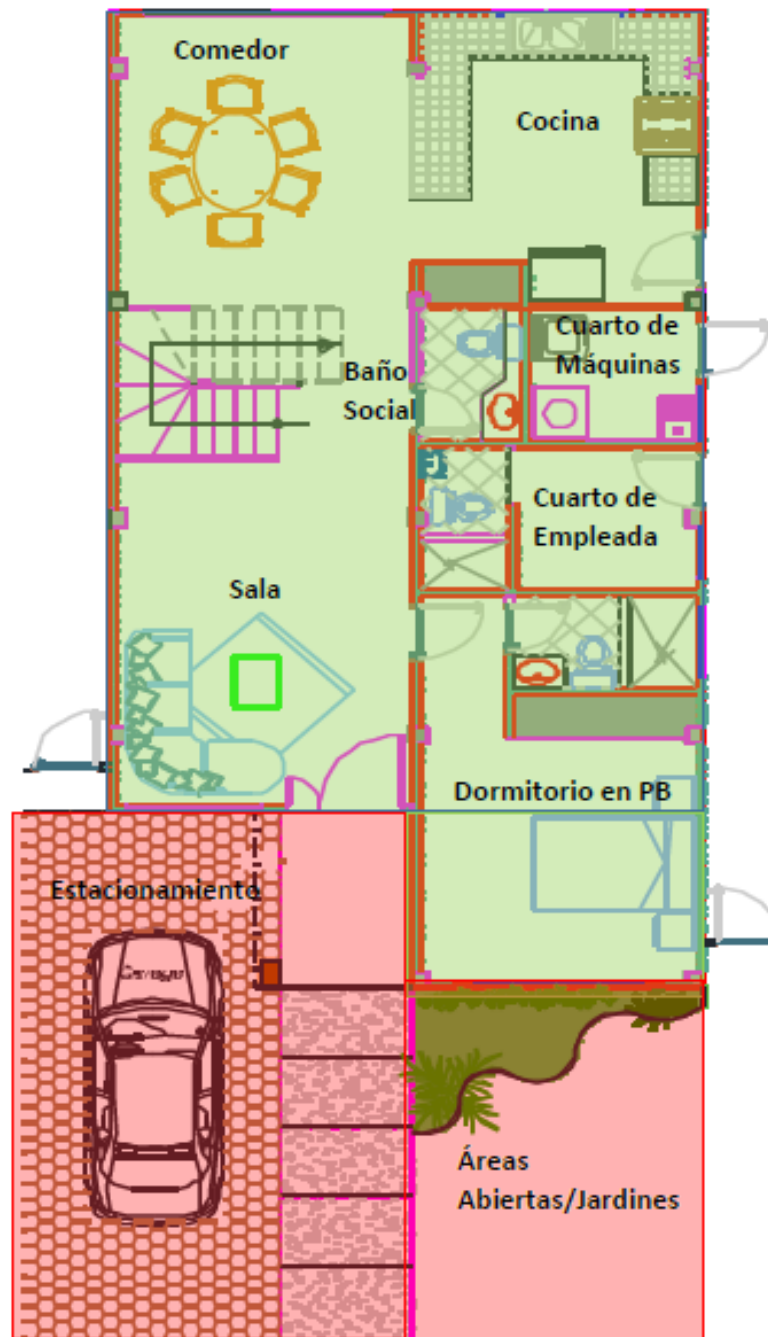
4 Planta Baja Vivienda Tipo No. 2
